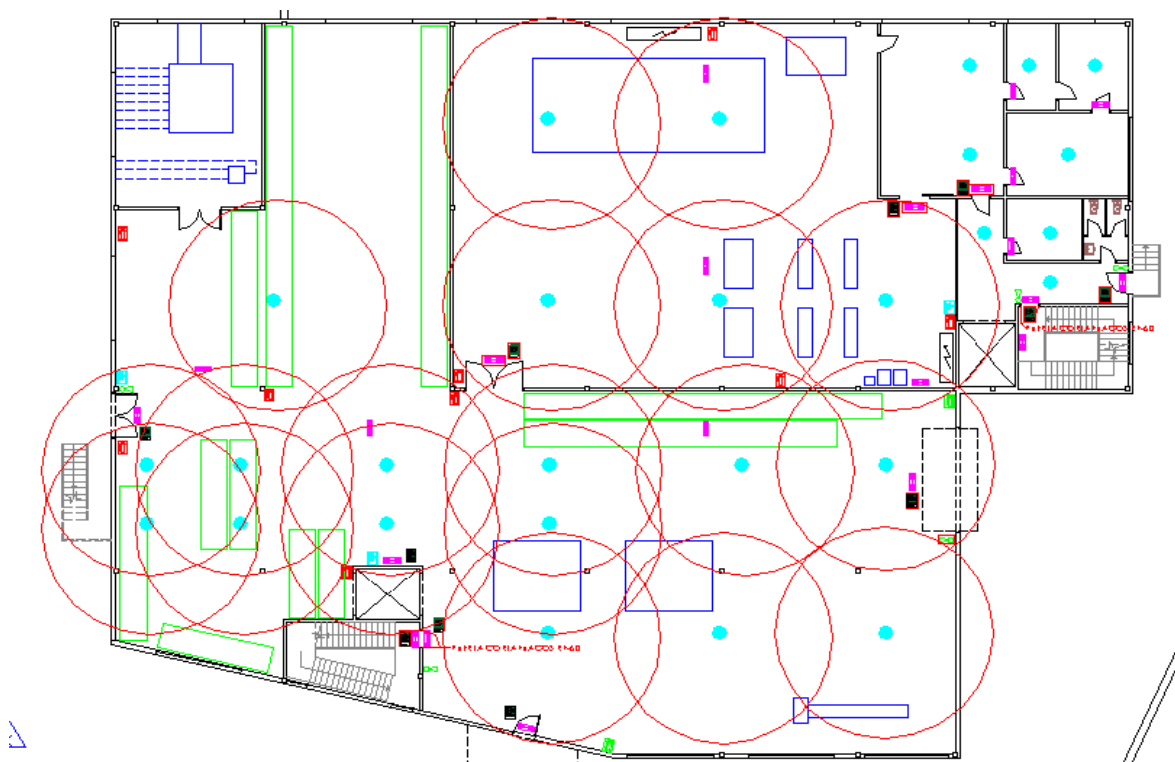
Superficie cubierta por los detectores en la planta baja del edificio Almacén
